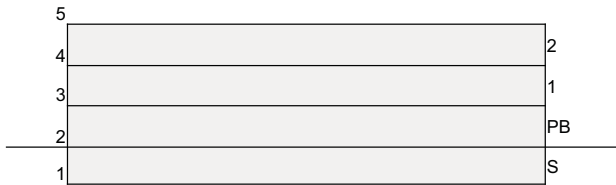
Corte por fachada en zona de biblioteca, [elaboración propia].
